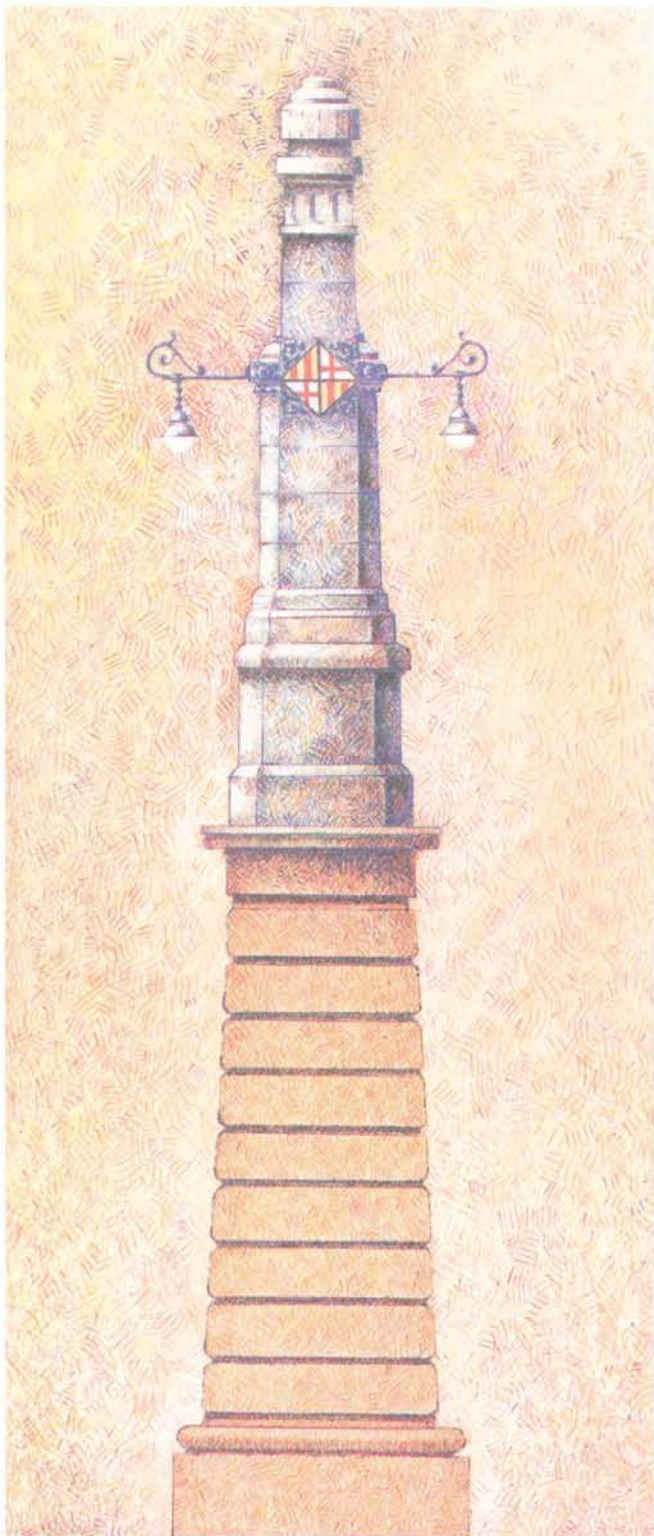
Alzado de un pilono. Vista transversal. (Dibujo de Ignacio Bartolomé.)
